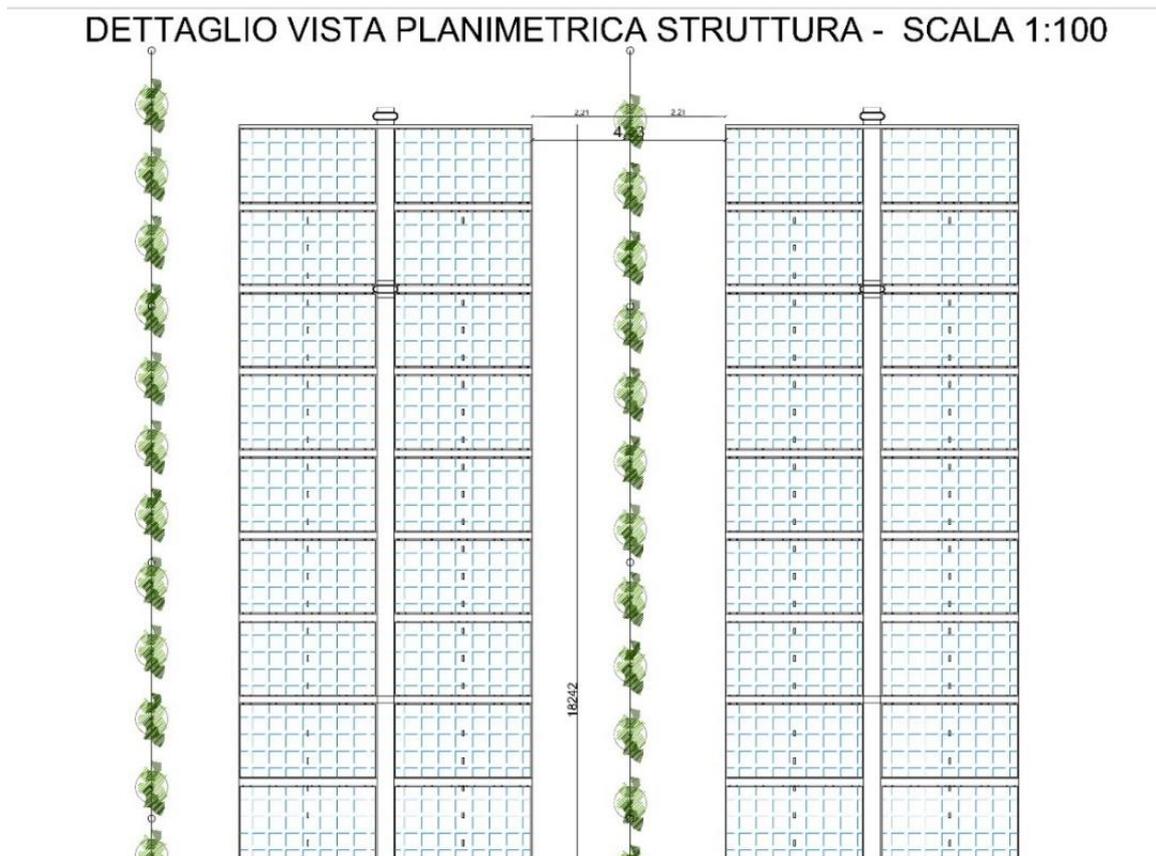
Dettaglio planimetrico della coltivazione dell'uva da tavola
